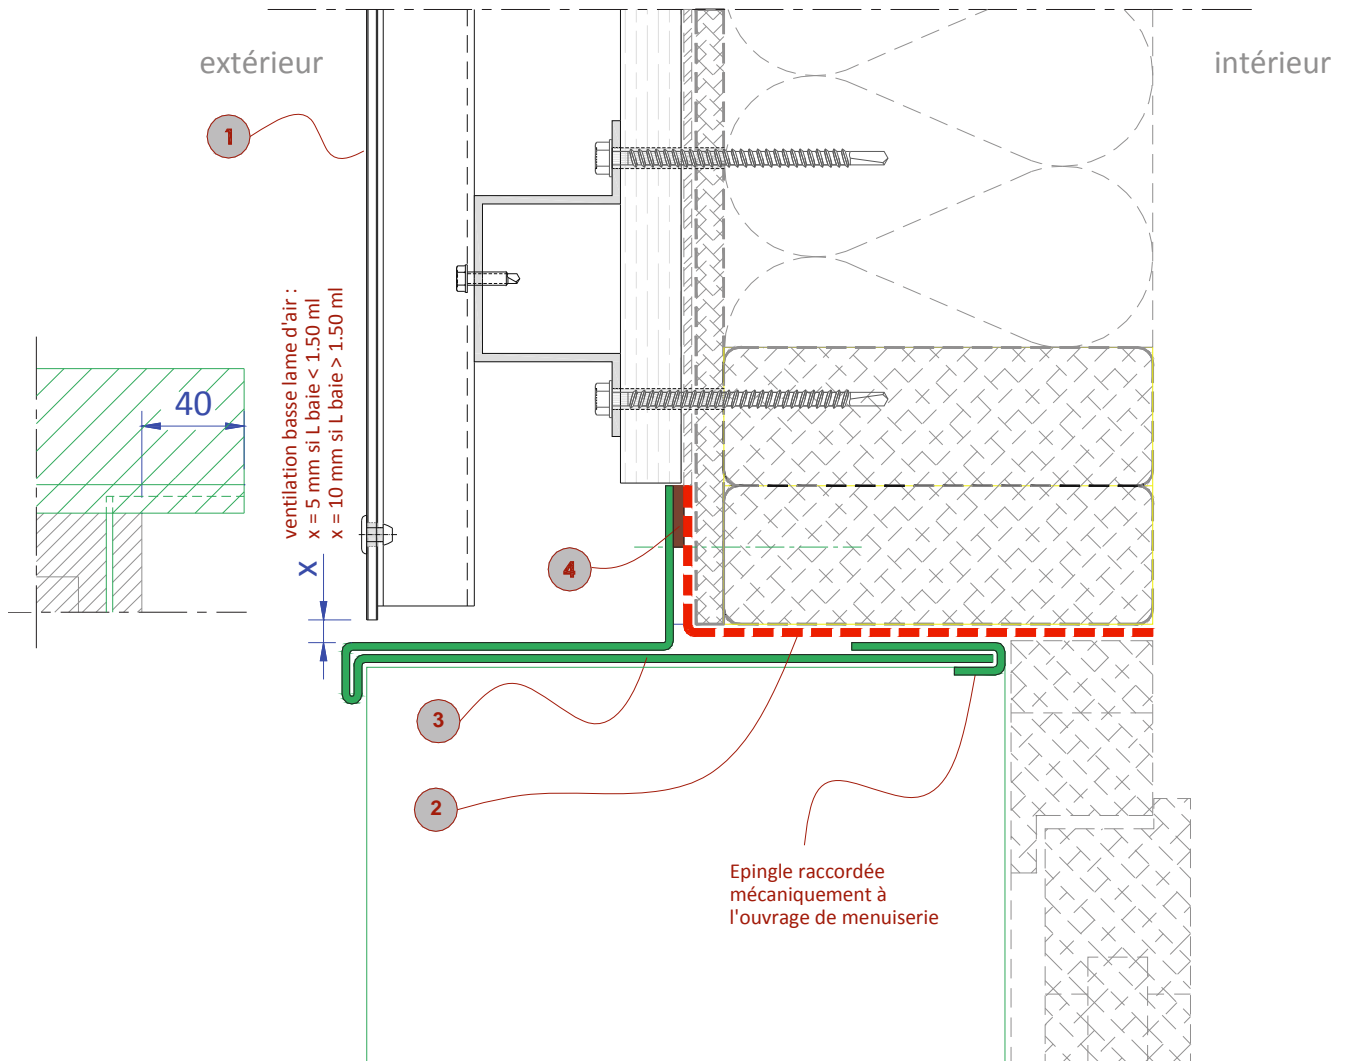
Pose sur COB – Coupe sur linteau de baie
